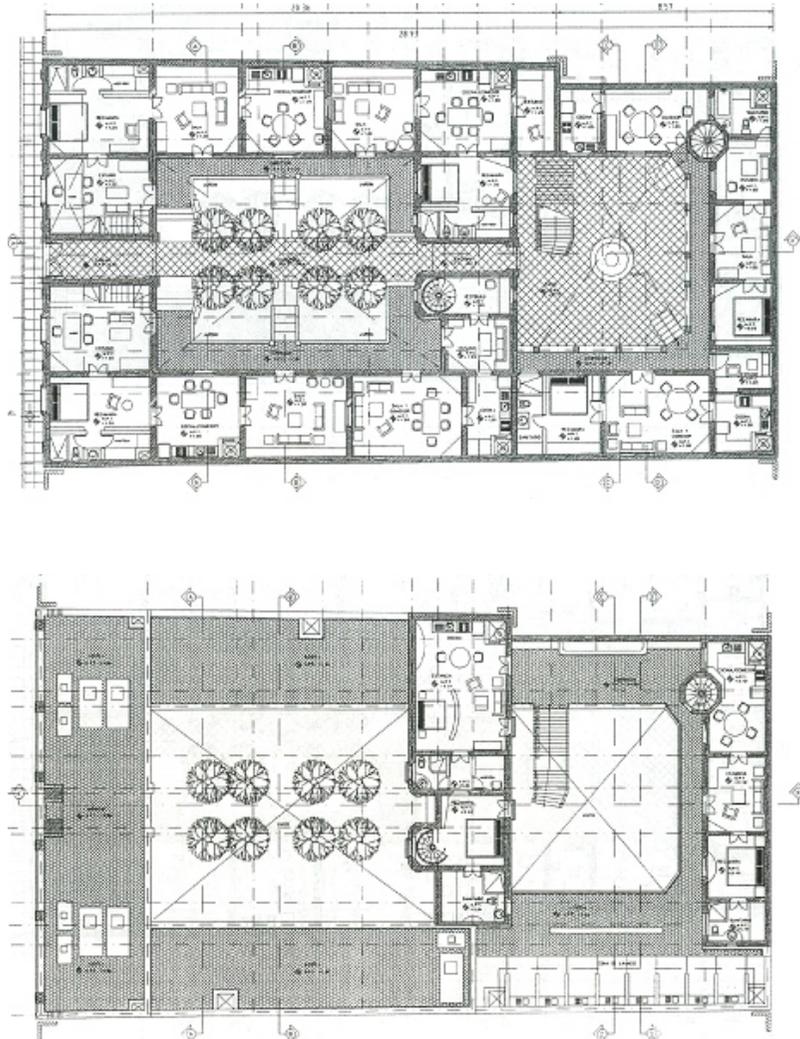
Planta baja y planta alta de la Rehabilitación de la Casa de los Perros.
